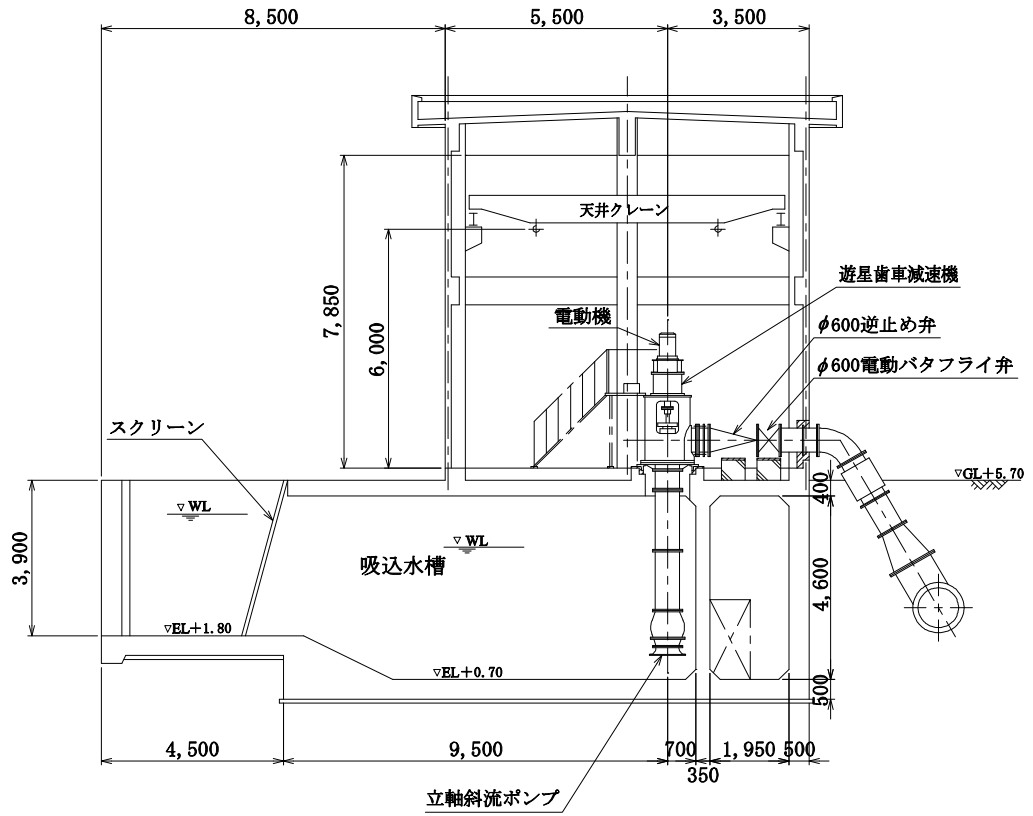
(a)-参 立軸斜流ポンプ平面図（例）
